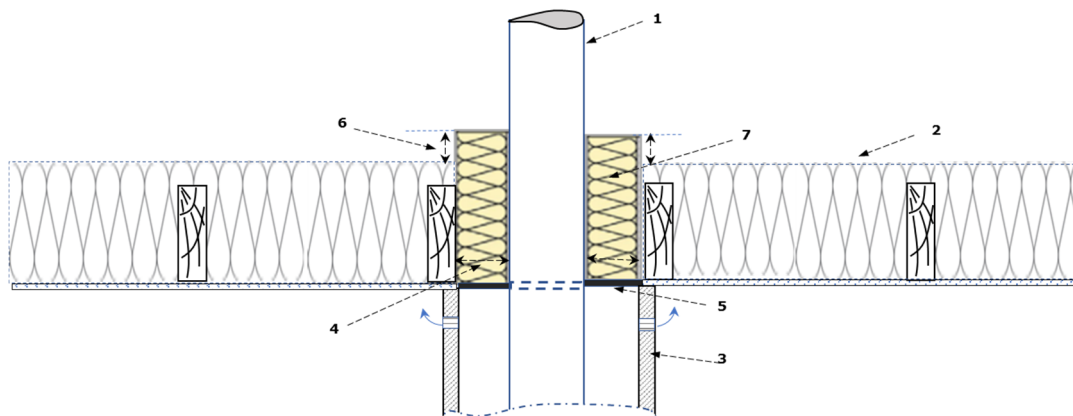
Coupe verticale : Traversée de plancher de combles perdus : conduit de fumée métallique avec dispositif de coffrage et de maintien du conduit selon NF DTU 24.1
